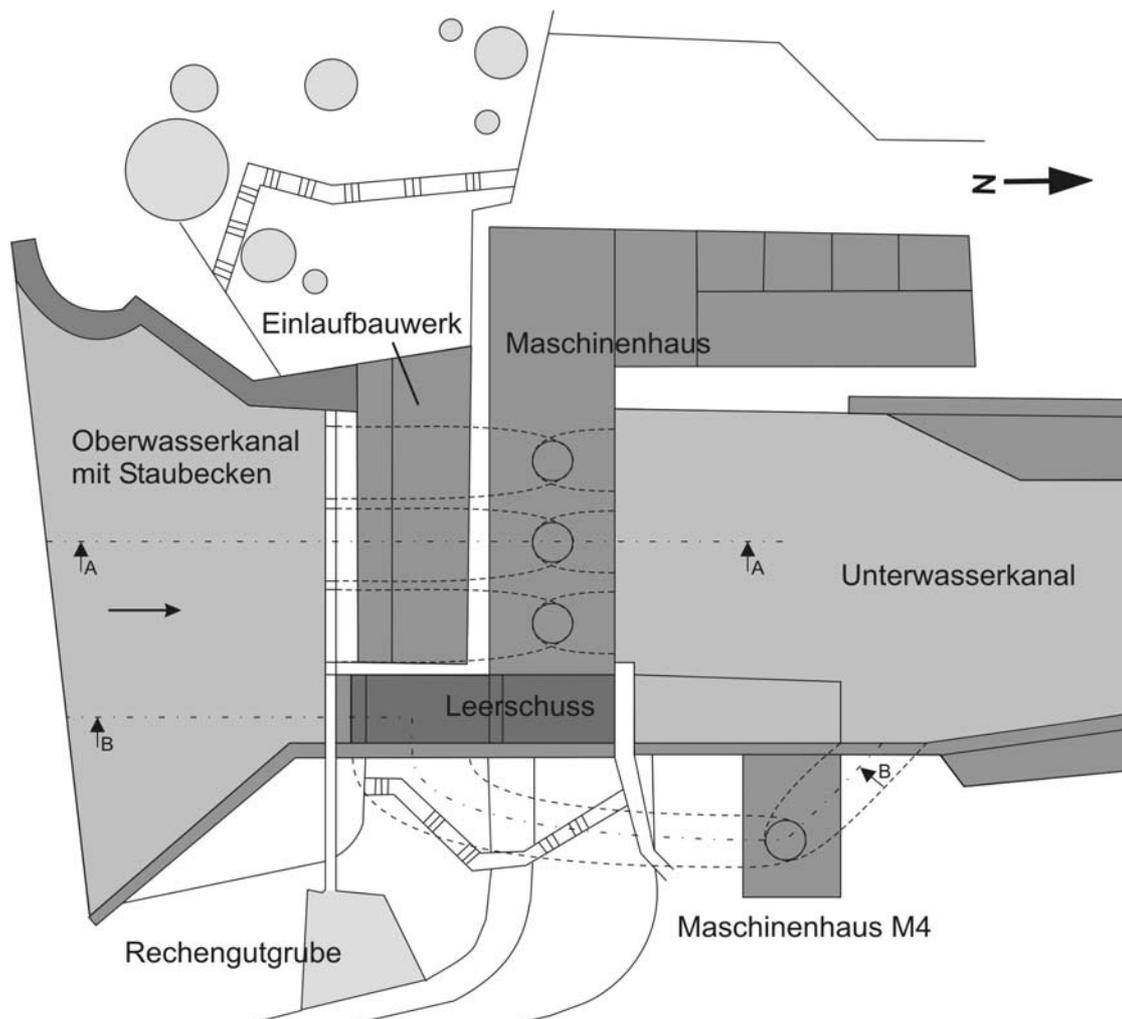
Grundriss des Kraftwerks Tannheim
